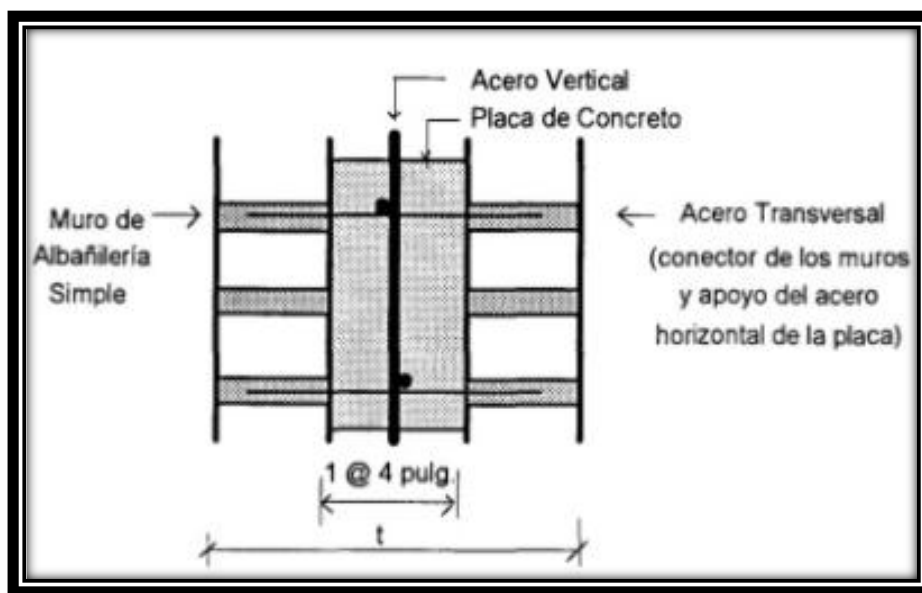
ALBAÑILERÍA ARMADA CON REFUERZO VERTICAL Y HORIZONTAL
